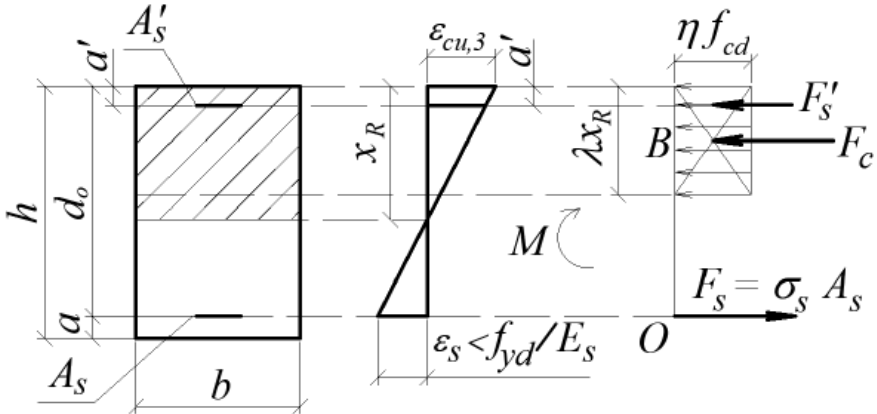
Розподіл деформацій, напружень та зусиль у нормальному перерізі з подвійним армуванням
